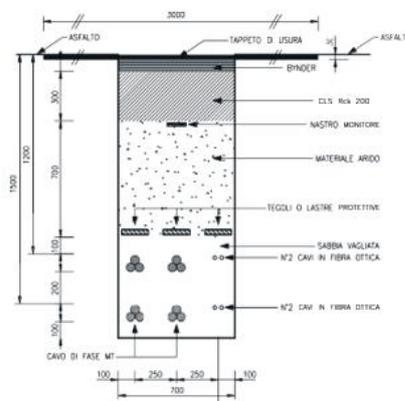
Sezione tipica di posa della linea in cavo su sede stradale
